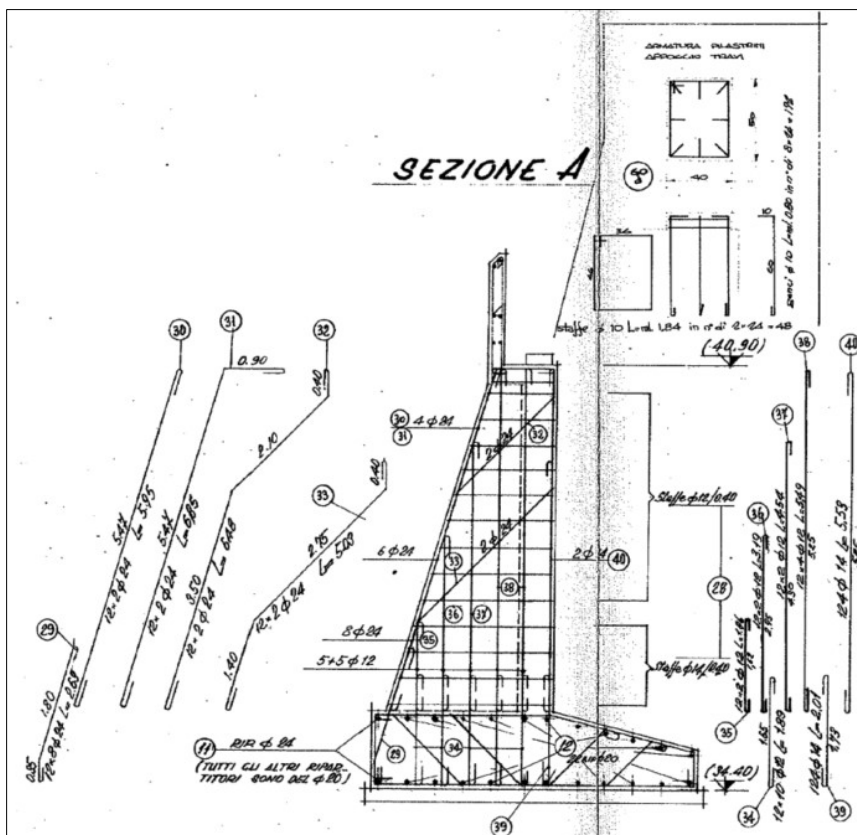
Documento as-built “Sottovia Via del Triumvirato dell’autostrada A14 al km 9+201” – Sezione trasversale con armature contrafforti
